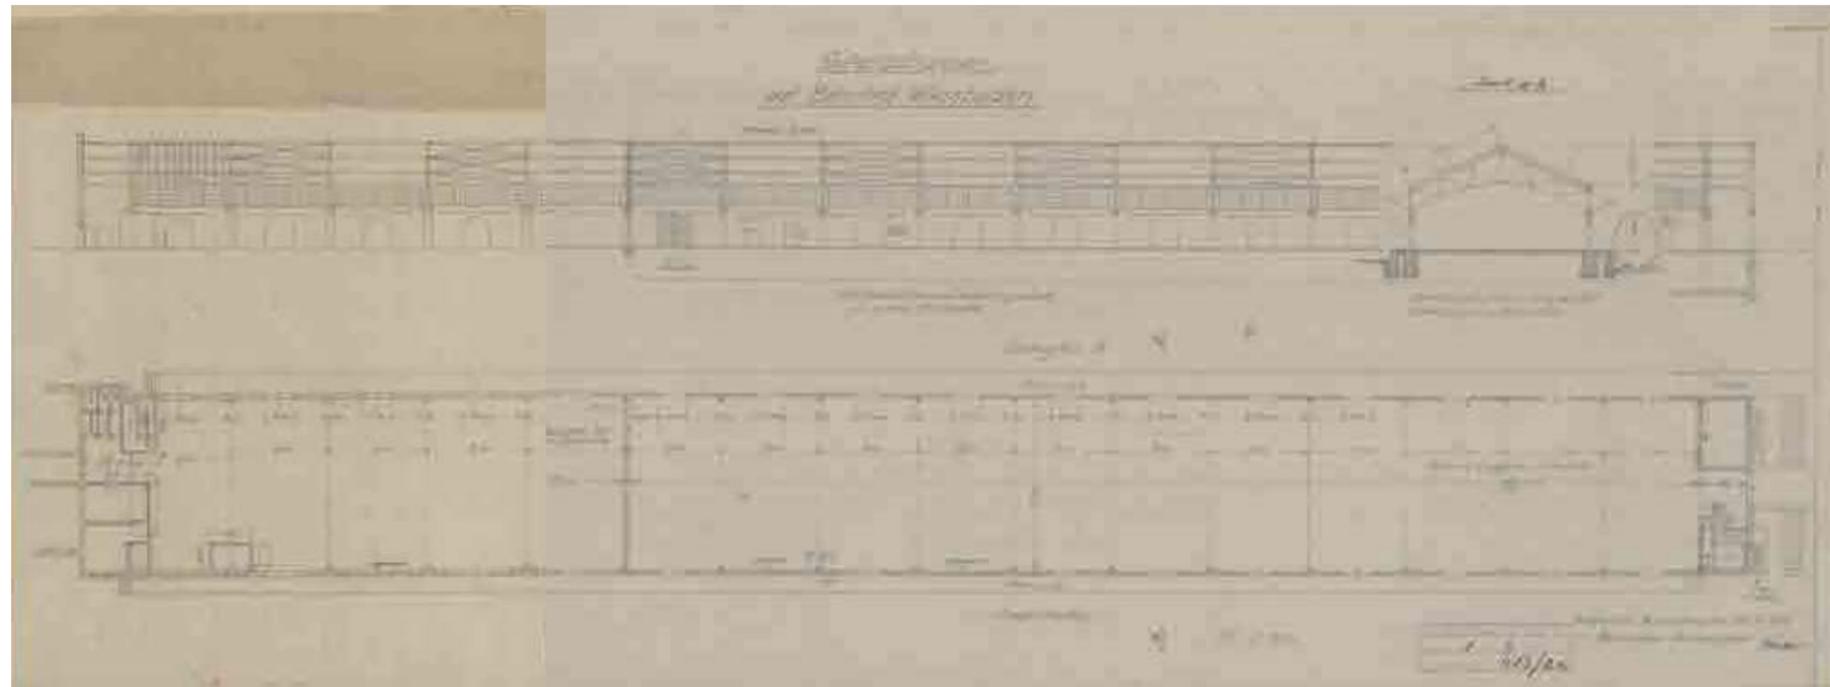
Stückgutshuppen: Längsschnitt und Grundriss des Erdgeschosses, 1946
